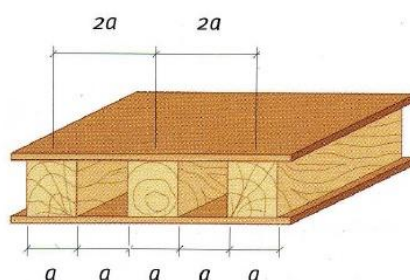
Esquema estrutural de um pavimento em madeira [Appleton, 2003]
